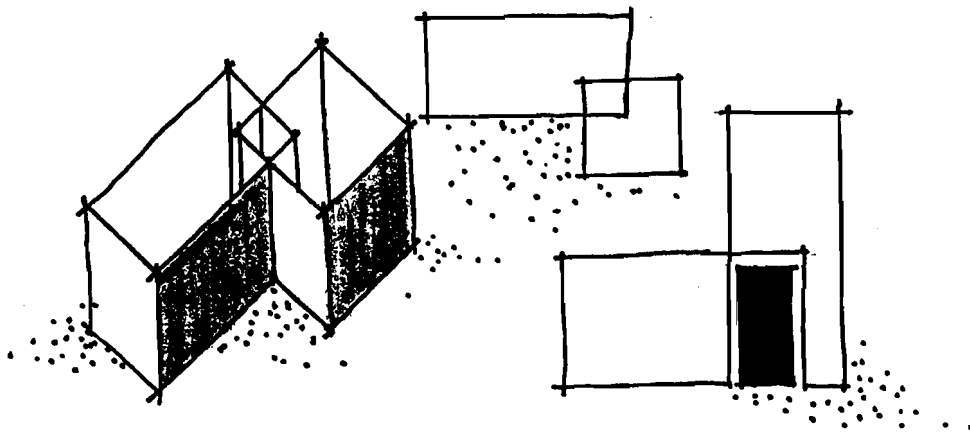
Bentuk Tata Bangunan Mengelompok
